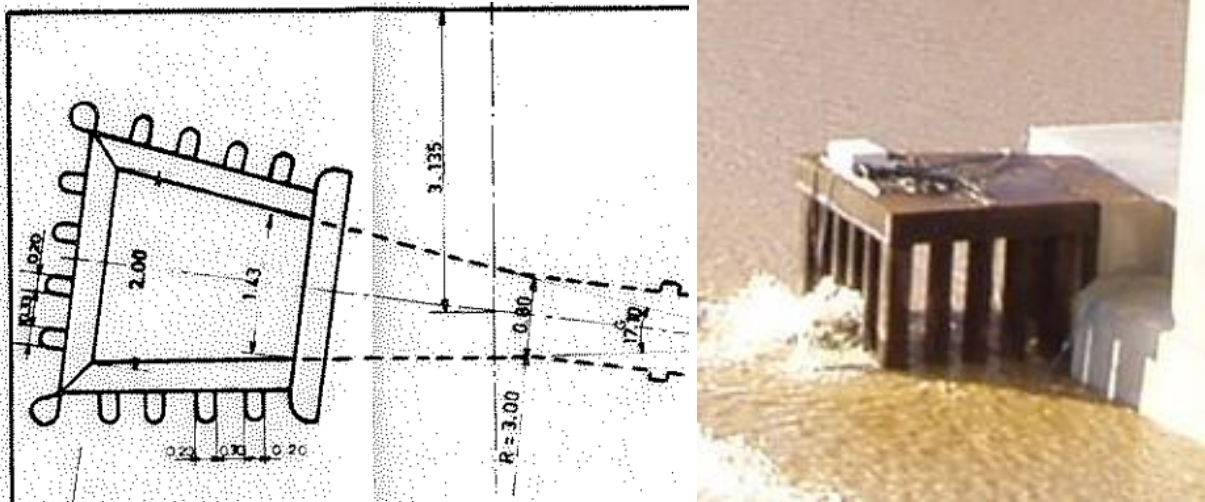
Plan de masse de la grille du conduit de vidange et vue externe générale
